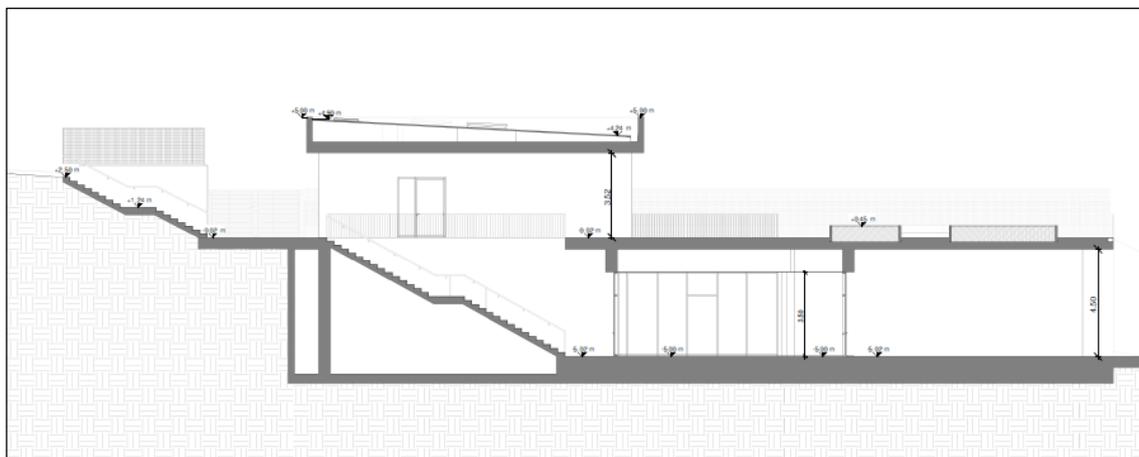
Sezione B-B del progetto definitivo dell'edificio centrale
